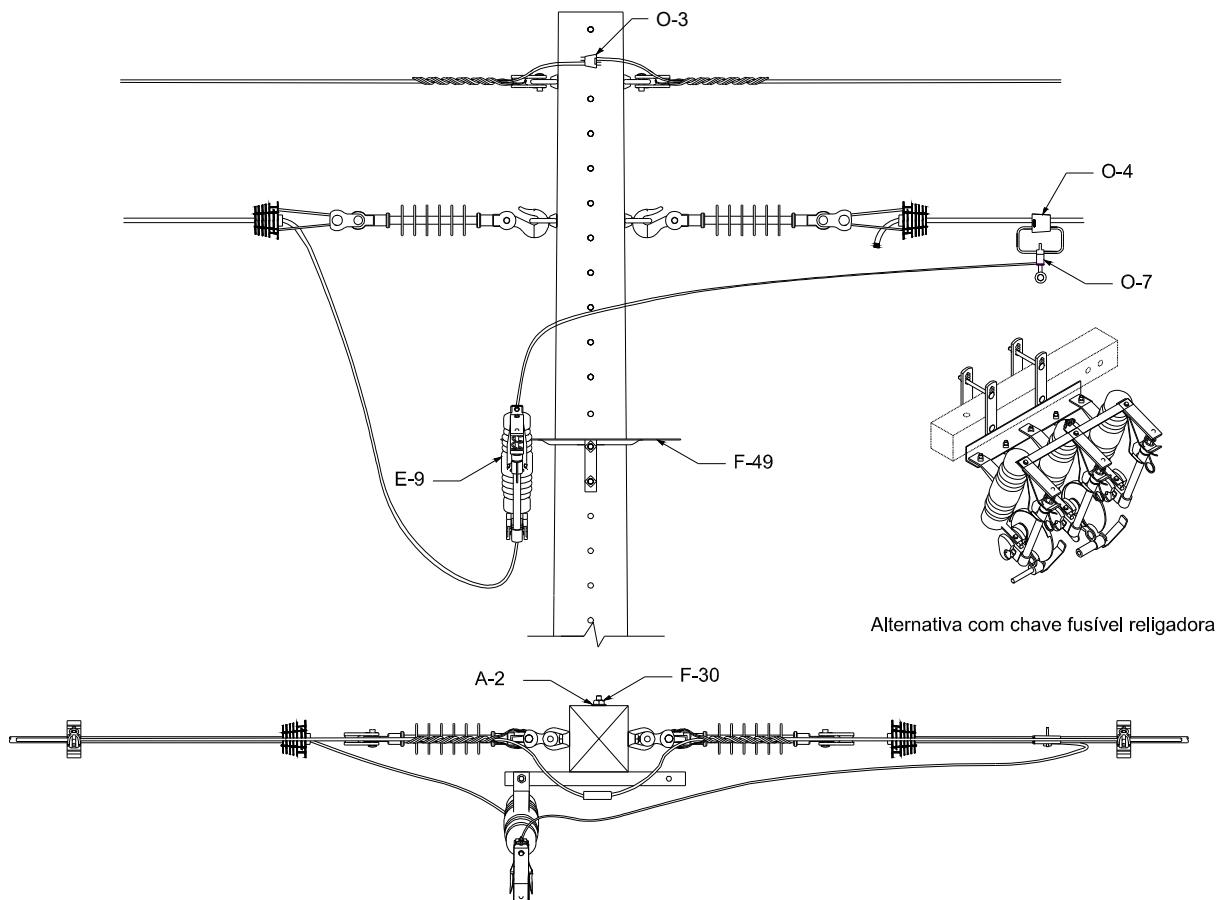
Instalação de equipamento – Chave fusível em seccionamento em 2º nível – Estrutura monofásica - Alternativa
